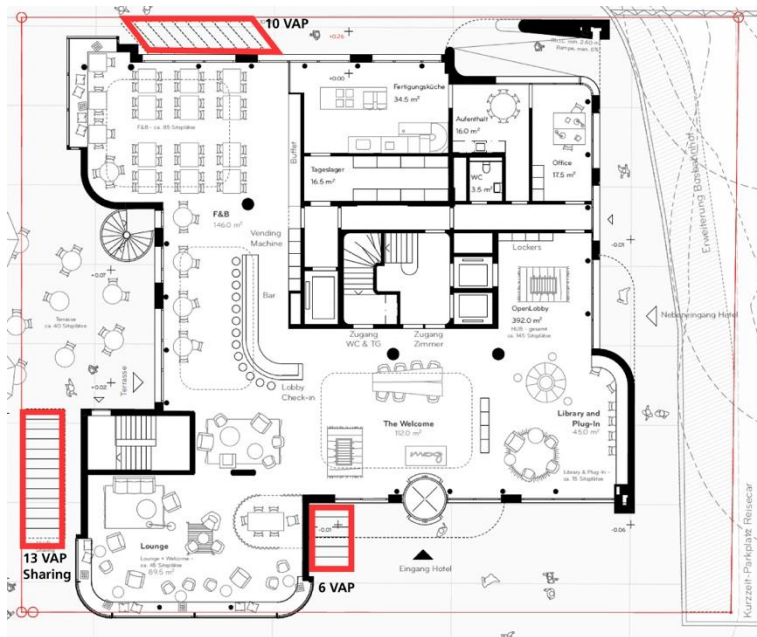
Ausschnitt Grundriss EG mit oberirdischen Veloabstellplätzen
